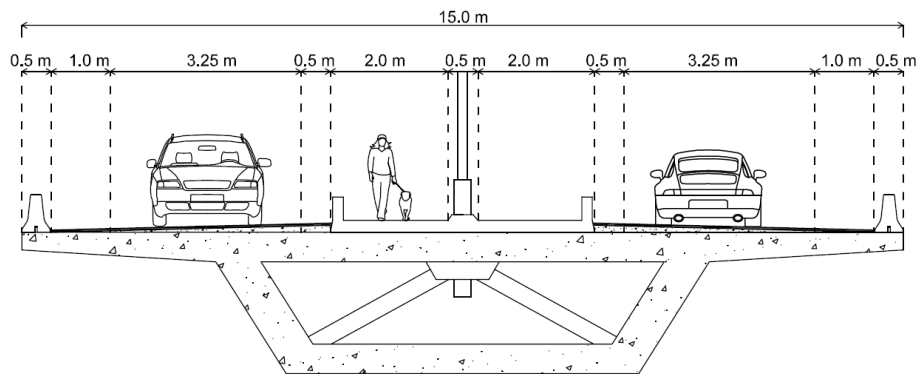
Perfil transversal do tabuleiro demonstrando a disposição dos elementos
